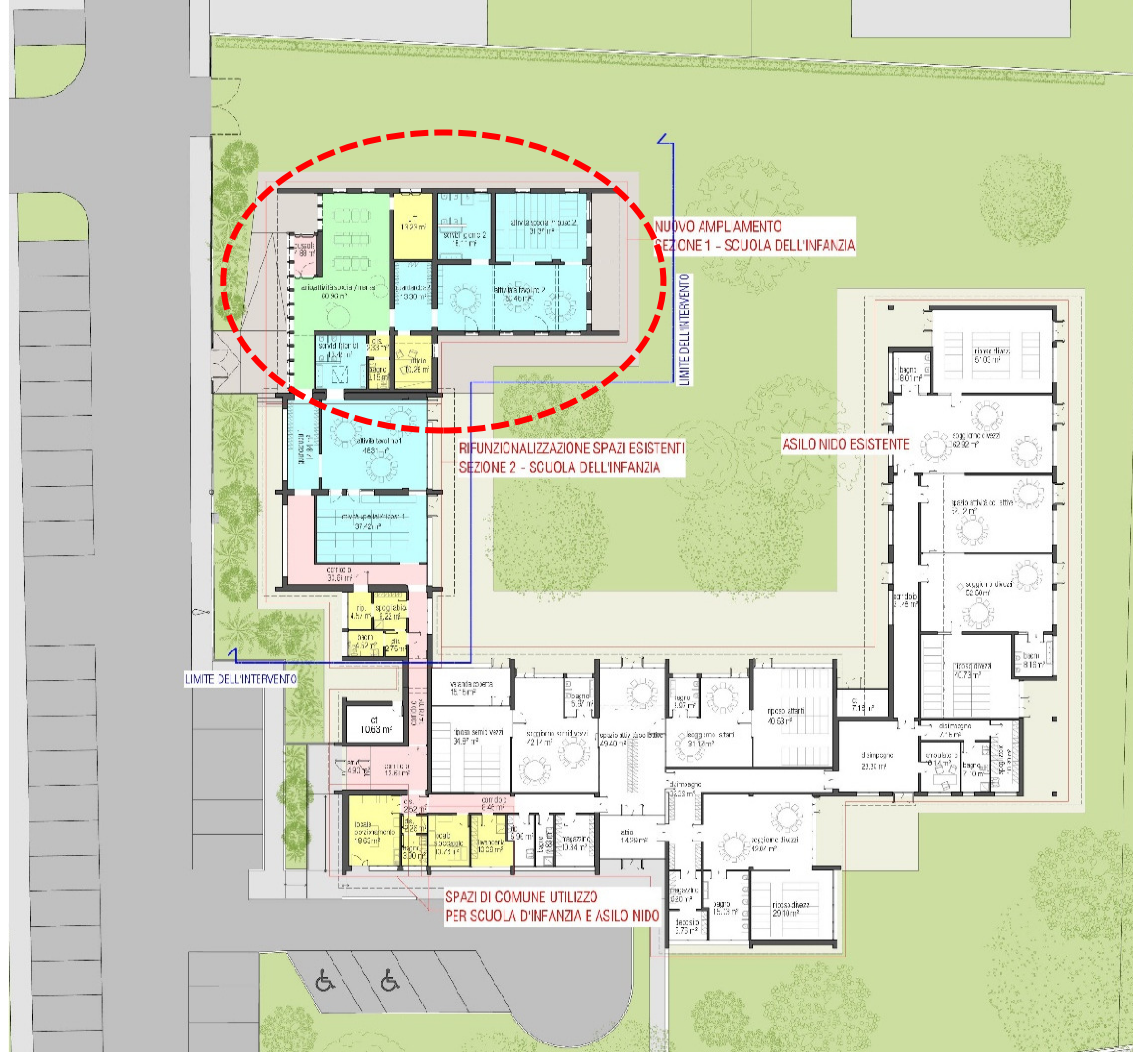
Planimetria generale progetto -evidenziato in rosso la porzione di edificio in ampliamento
